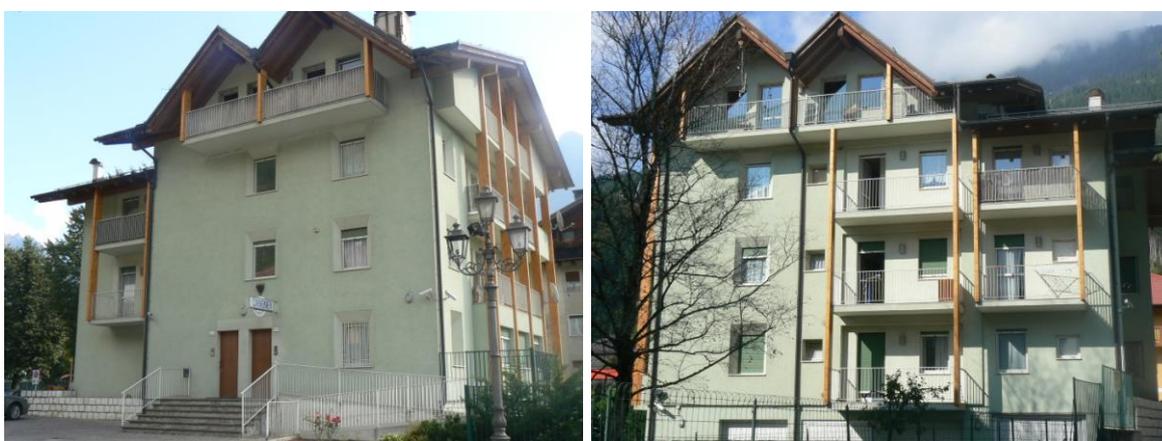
Facciata a ovest (foto a sinistra) e facciata a est (foto a destra) della Caserma dei Carabinieri
